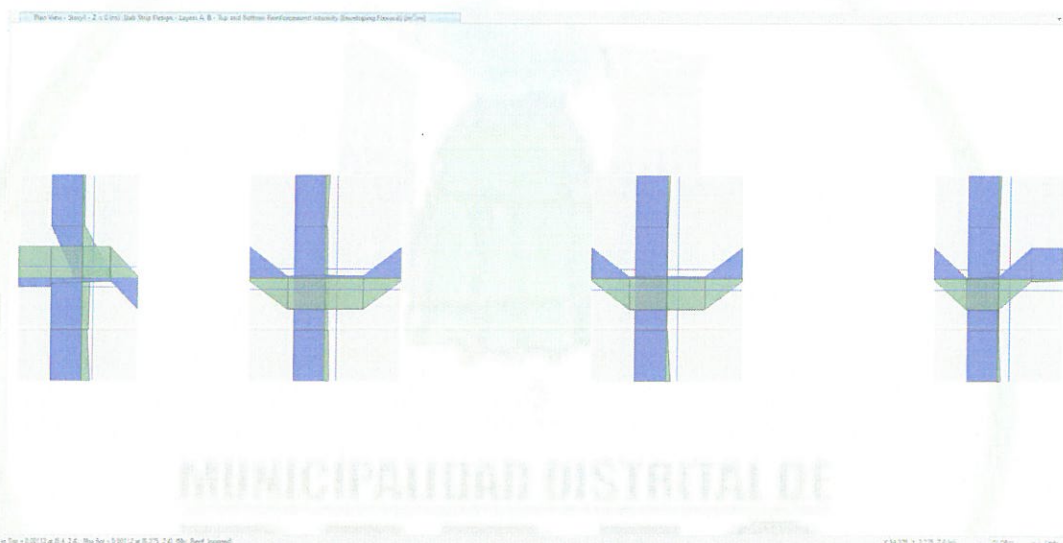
Vista del área de acero en la zapata en el eje "X", "Y"
